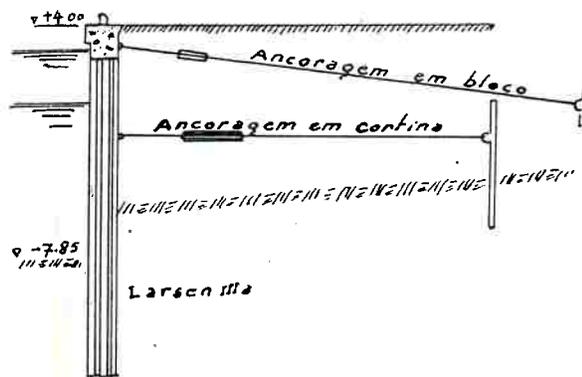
Perfil de estacas pranchas de aço — com ancoragem em blocos cortinas — Porto de Cabedel.
